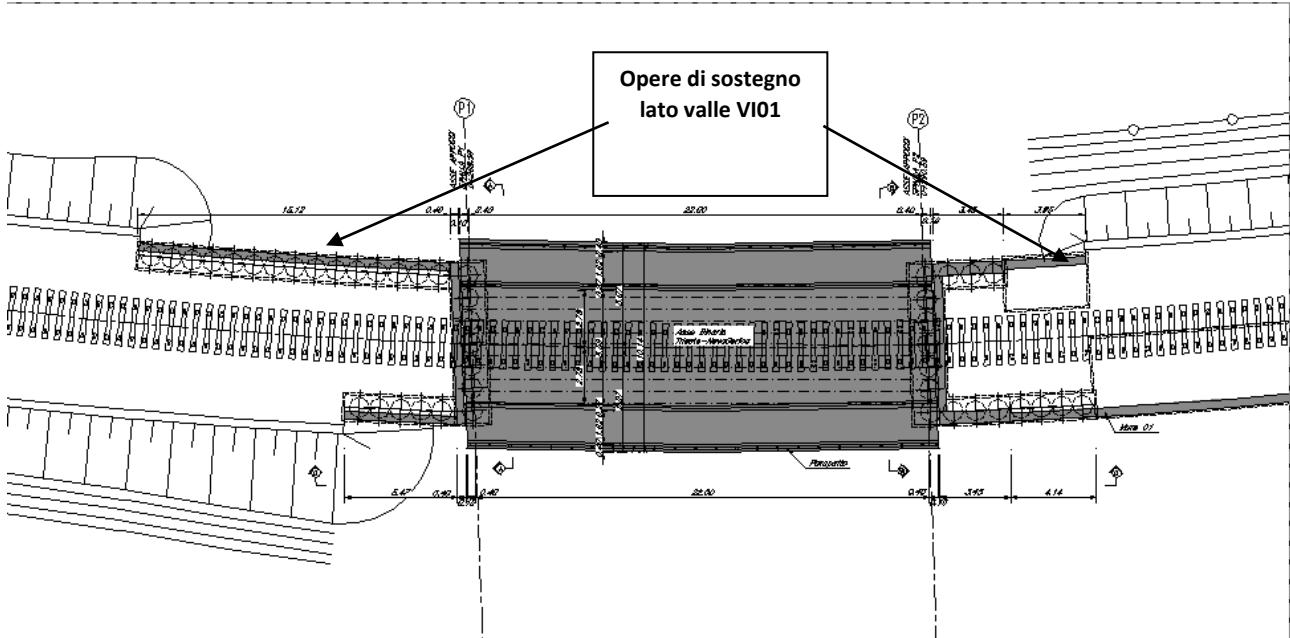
Planimetria con ubicazione dell'opera di sostegno lato valle
